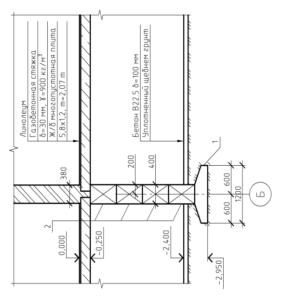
Пример оформления поперечного разреза для ленточного фундамента мелкого заложения
